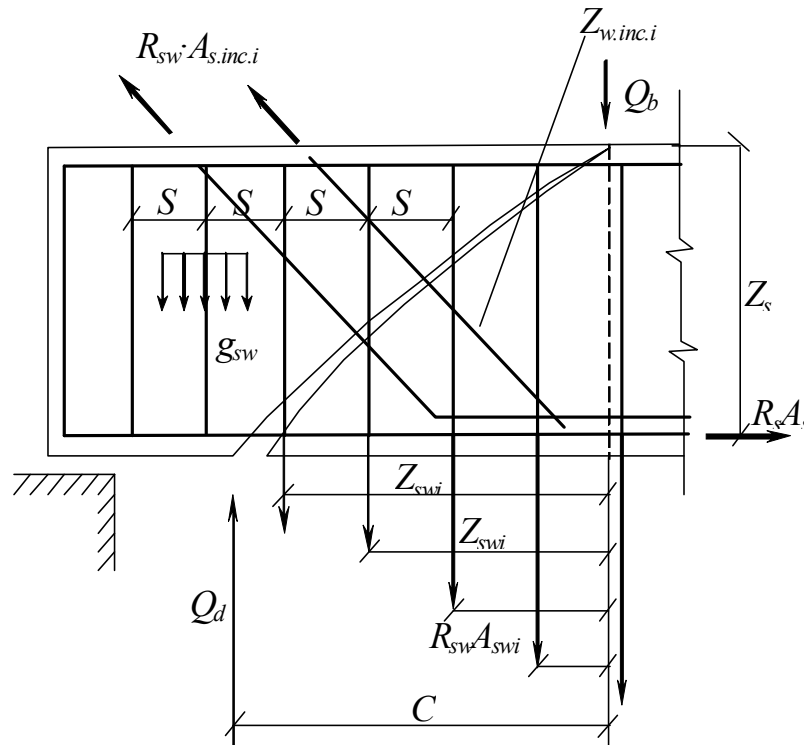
Расчетная схема усилий для расчета по наклонным сечениям
